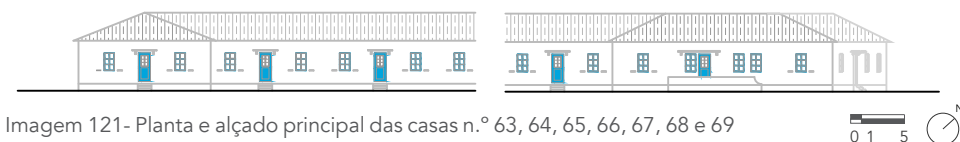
Planta e alçado principal das casas n.º 63, 64, 65, 66, 67, 68 e 69
